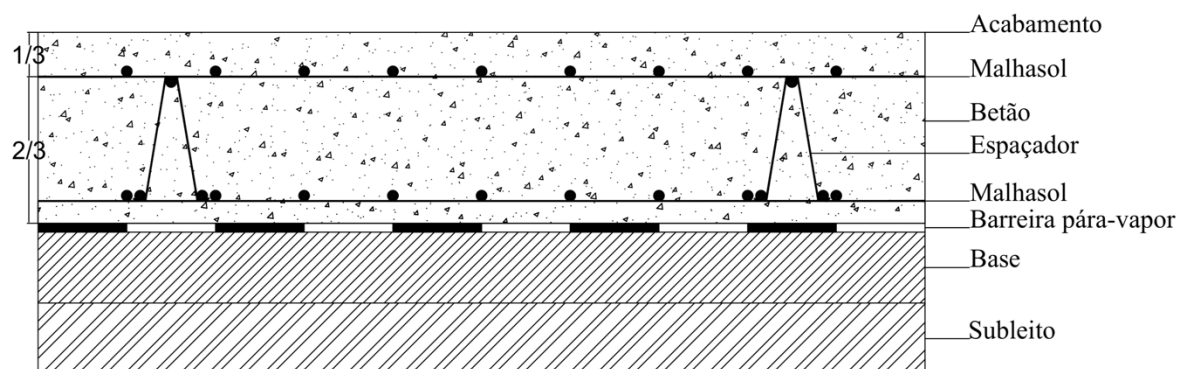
Pavimento de betão estruturalmente armado [adaptado 34]
